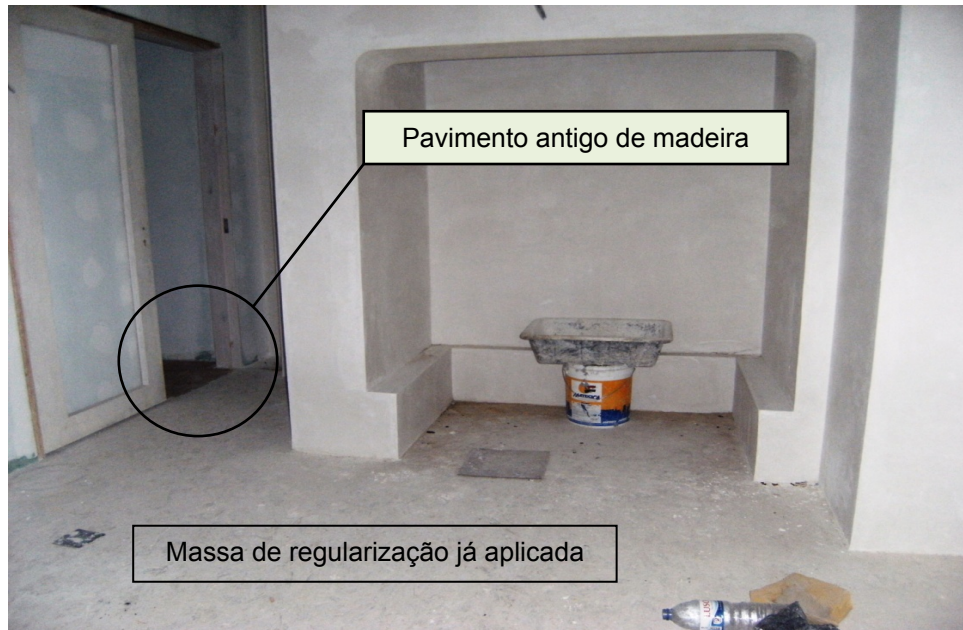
Aplicação de massa de regularização em pavimentos de madeira
